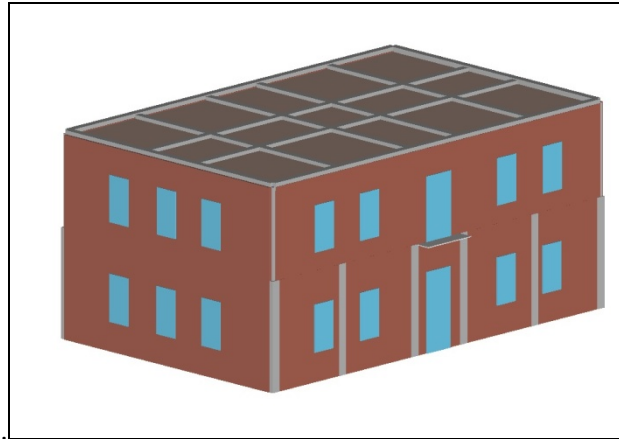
Impianto strutturale rilevato (sostegno del tetto a quattro falde)
